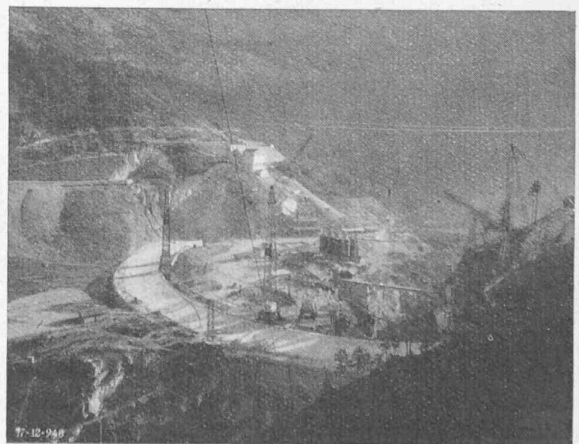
et 14. — Barrage du Piave en cours de construction.
